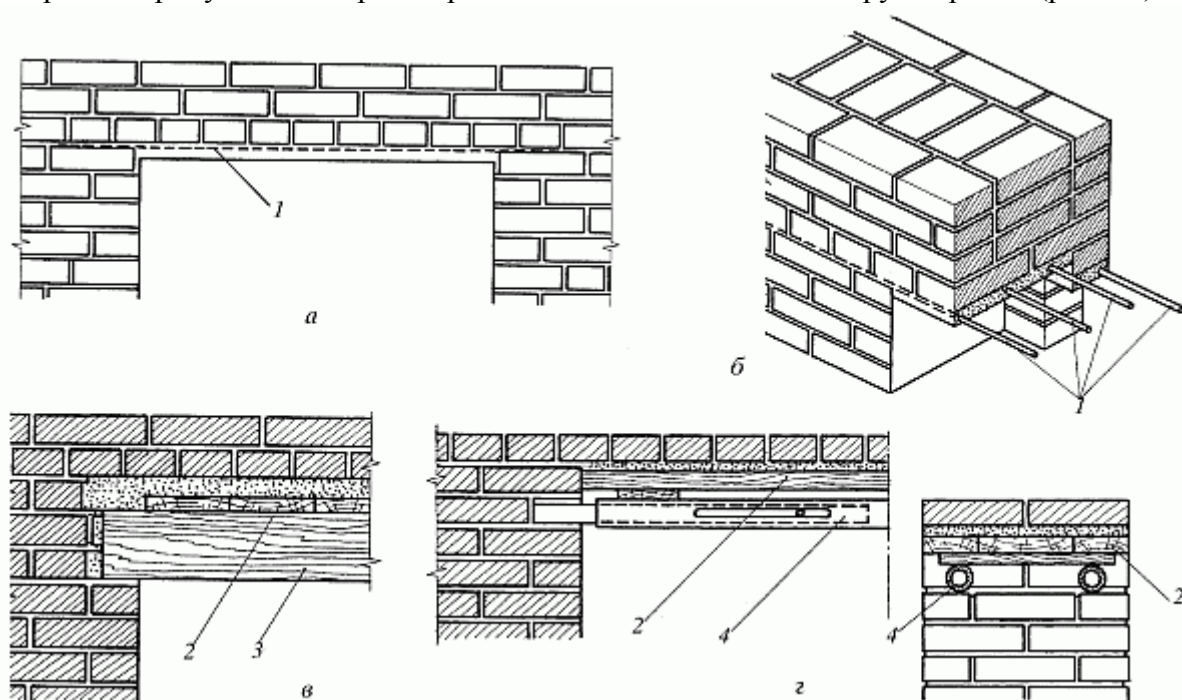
Кладка рядовых перемычек: а – фасад; б – разрез; в – кладка по дощатой опалубке; г – кладка на инвентарных кружалах; 1 – арматурные стержни; 2 – доски; 3 – деревянные кружала; 4 – трубчатые кружала
